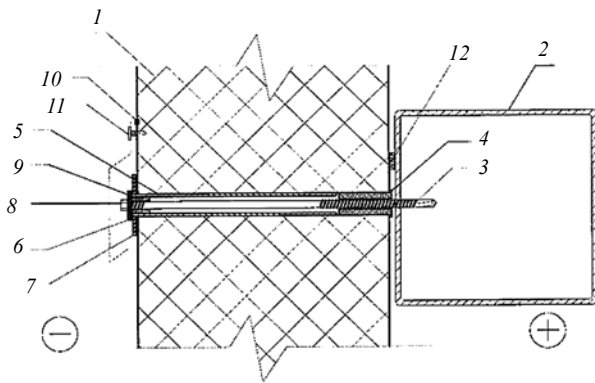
Модель ЛСК¹¹. Общий вид конструкции: 1 — ЛСК-панель; 2 — каркас здания; 3 — самонарезающий винт; 4 — центрирующая втулка; 5 — дистанционная втулка; 6 — разрушаемый элемент с шайбой; 7 — усиливающая шайба; 8 — головка самонарезающего винта; 9 — центрирующий элемент; 10 — фасонный элемент; 11 — винт; 12 — уплотнитель
